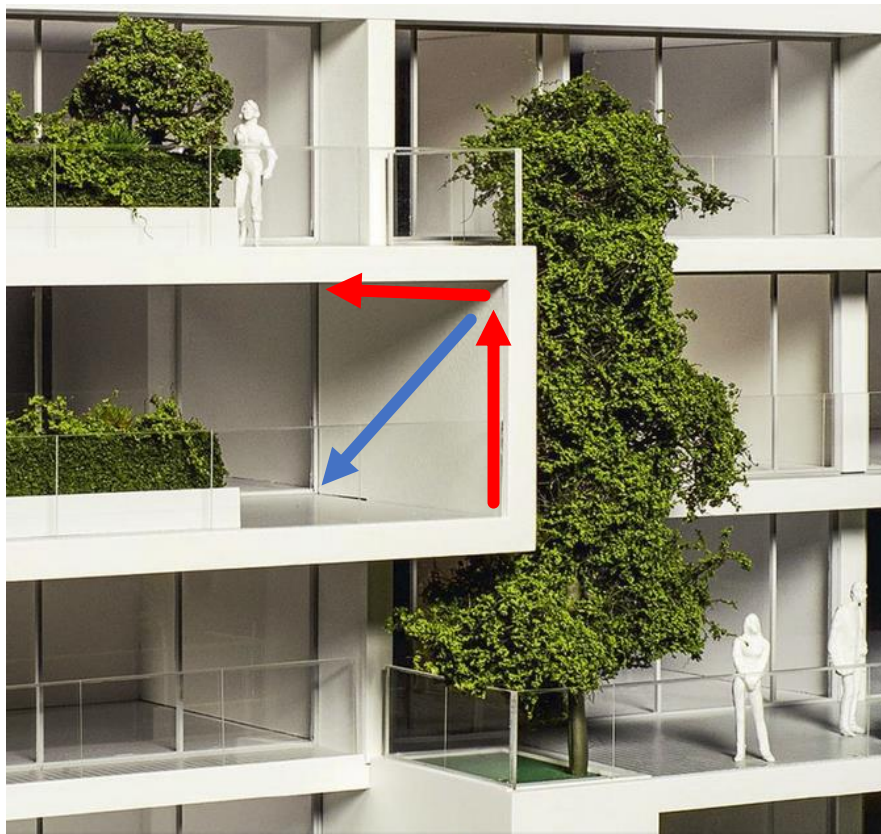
Fonctionnement structurel des murs en drapeaux permettant de tenir les balcons
